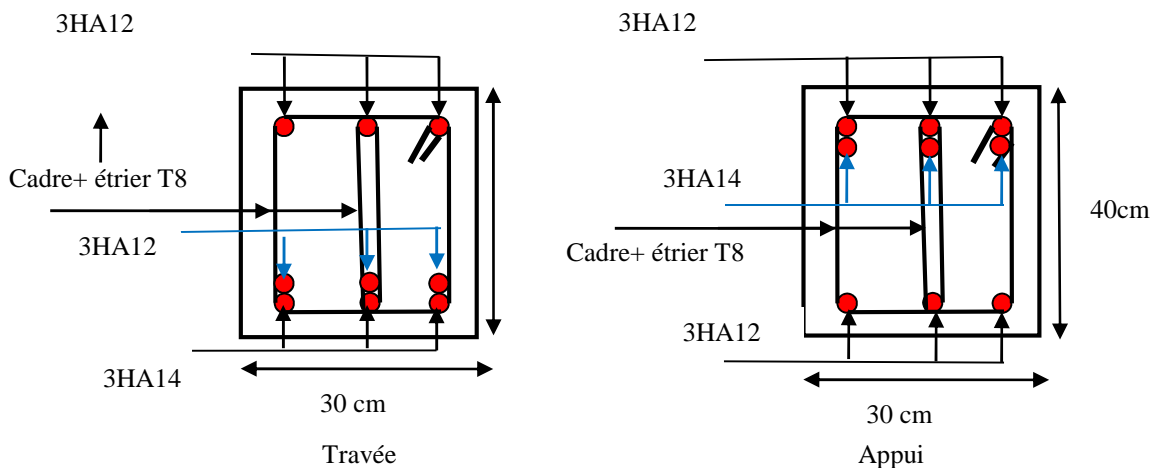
Schéma de ferrailage de la poutre secondaire de l'étage courant et terrasse inaccessible
